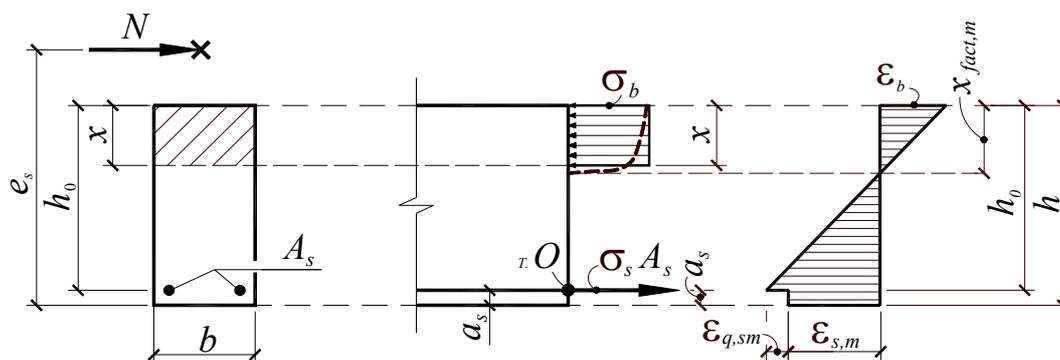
К определению x , σ_s , σ_b во внецентренно сжатых железобетонных конструкциях при принятой гипотезе средних деформаций бетона и арматуры в поперечном сечении составного стержня с учетом средних условных сосредоточенных взаимных смещений бетона и арматуры
